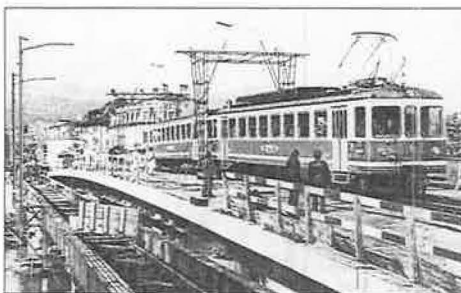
Rohbau der Strassenbrücke wird vorübergehend für Bahnbetrieb benutzt. Jetzt kann die alte
